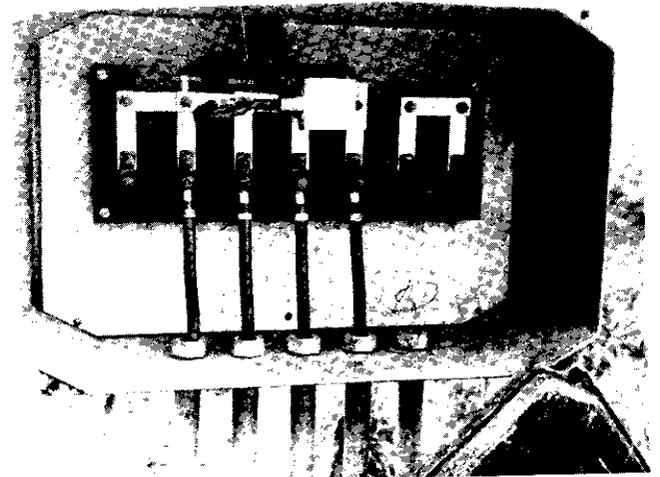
Detalhe interno de uma caixa de medição e interligação.
